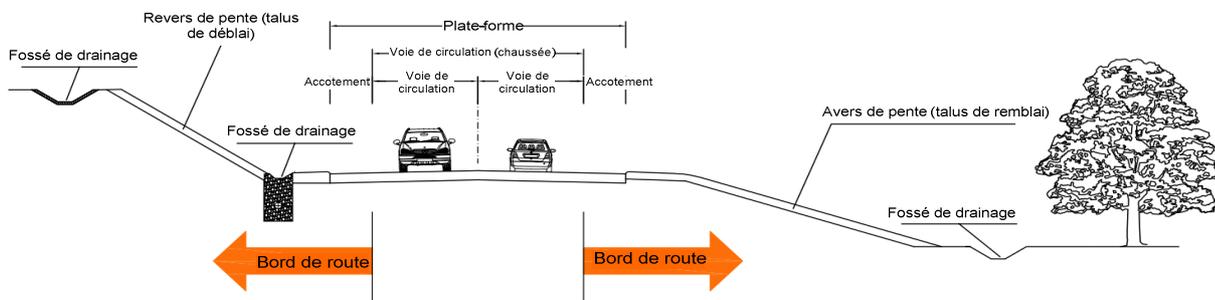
Coupe transversale de la chaussée avec des exemples d'éléments riverains (de bord de route)
